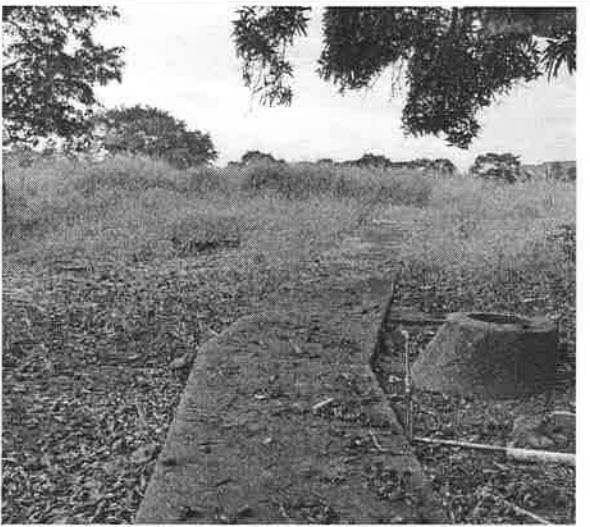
Vista de cámara de inspección del sistema de alcantarillado.
